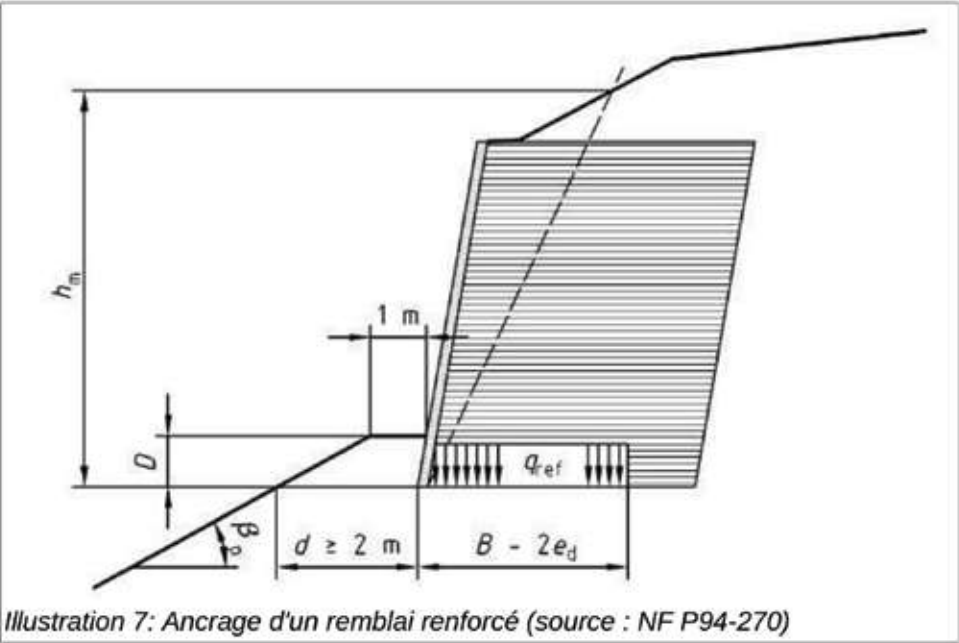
Ancrage d'un remblai renforcé (source : NF P94-270)
